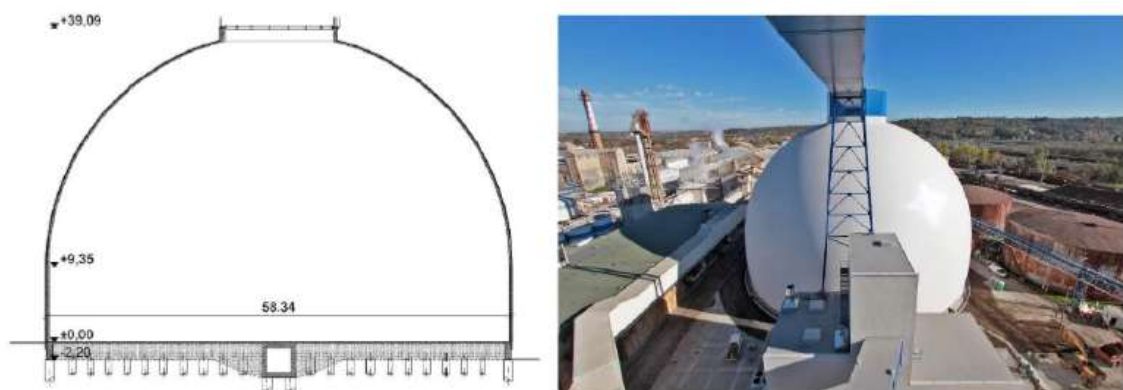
Caraterísticas gerais da estrutura e a fundação.
